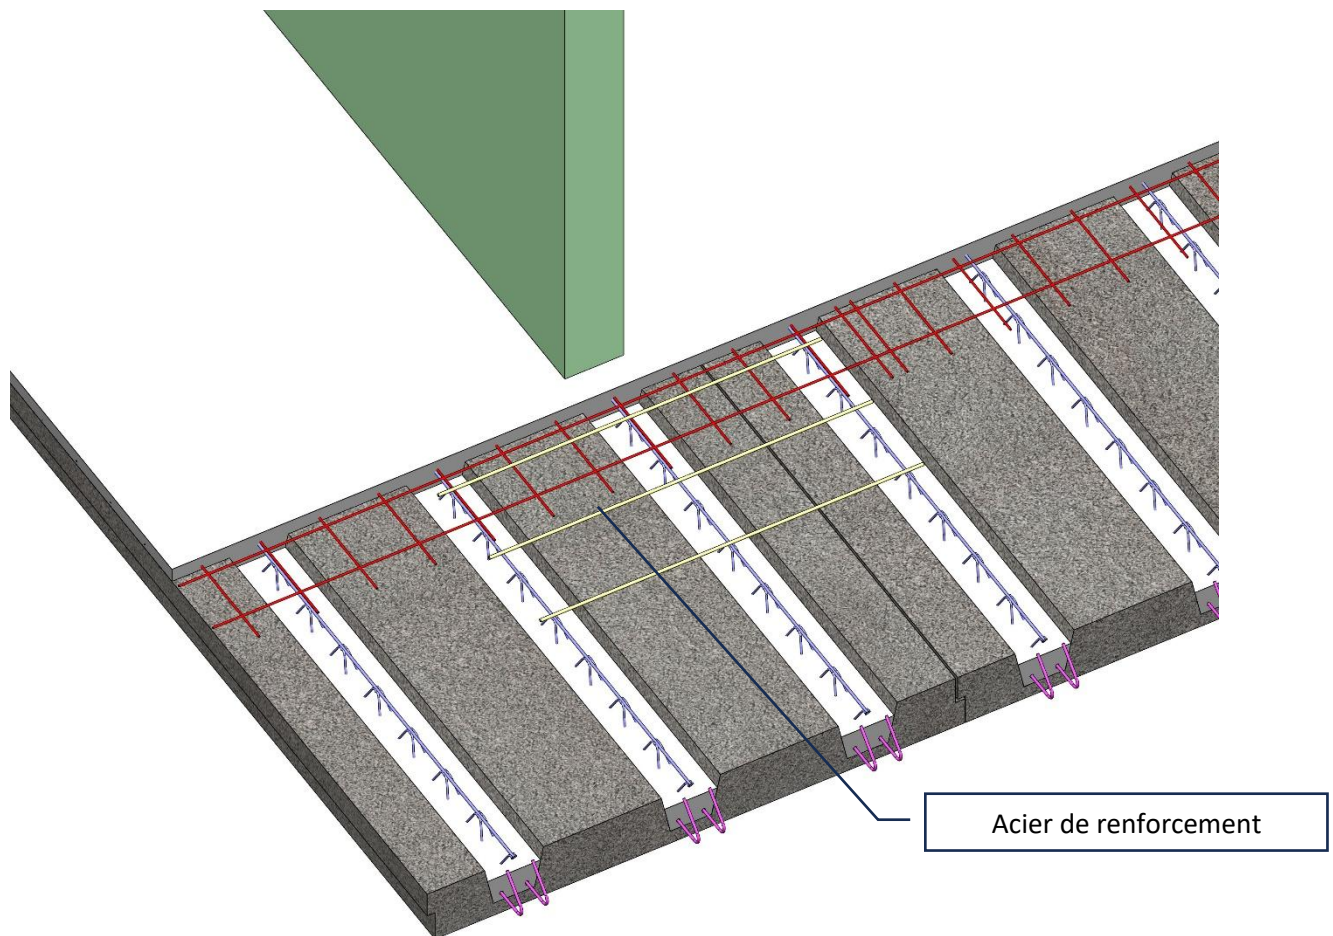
Exemple de prédalle DS1 avec renforcement pour reprise d'une charge parallèle aux raidisseurs béton
